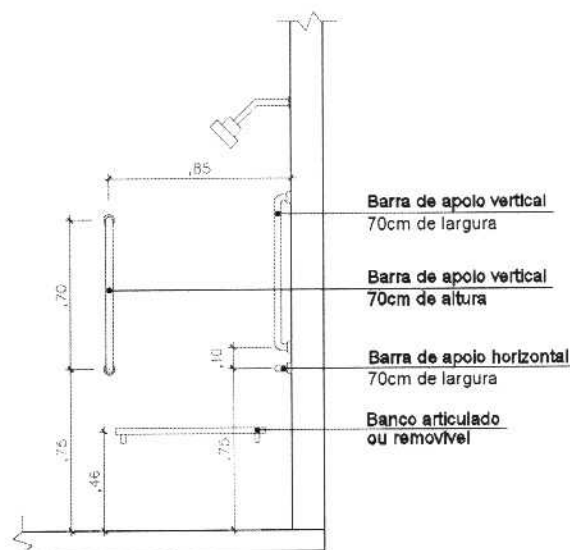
Vista 02 - detalhe de instalação da boxe acessível
